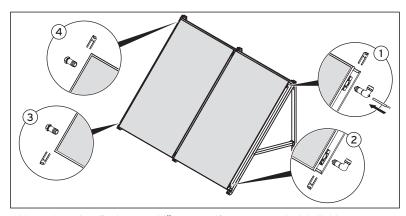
Hydraulische Anschlüsse montieren (1 - 5 Flachkollektoren)
